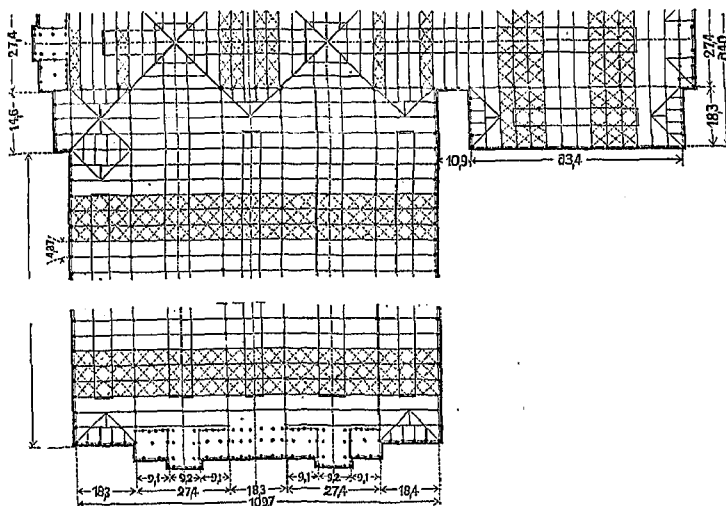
Grundriss eines Theils der Maschinenhalle.
